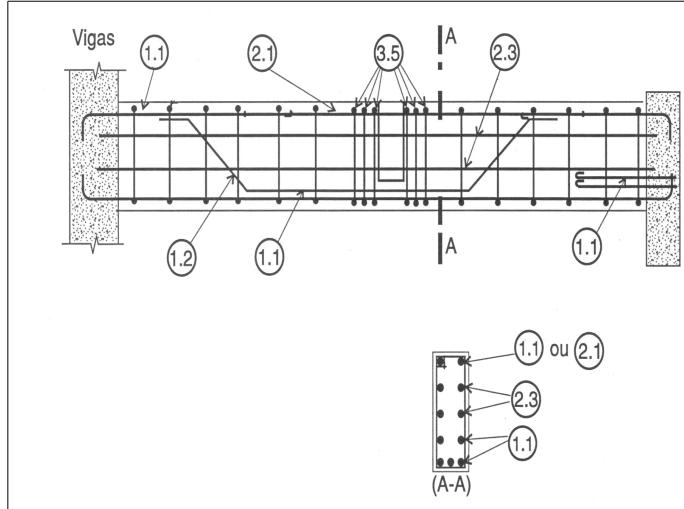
Esquema de armadura de uma viga de concreto armado. In: FUSCO, Péricles Brasiliense. *Técnica de armar as estruturas de concreto*. São Paulo: PINI, 1995. p. 54 (Adaptado).
